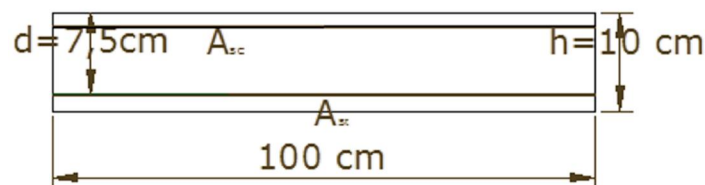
Dimensions de la section dangereuse de l'acrotère pour une bande d'un mètre.
